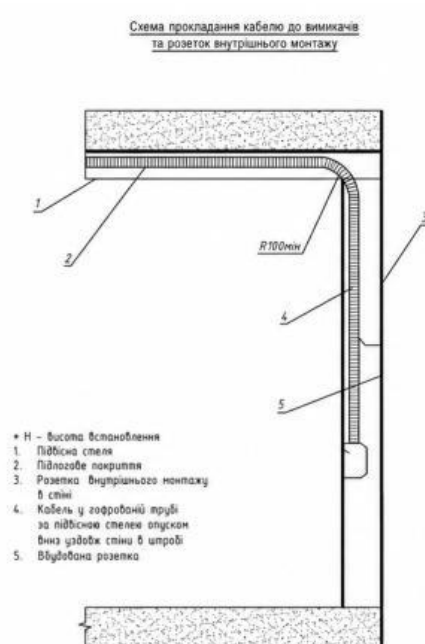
Схема прокладання кабелю до вимикачів і розеток внутрішнього монтажу.
